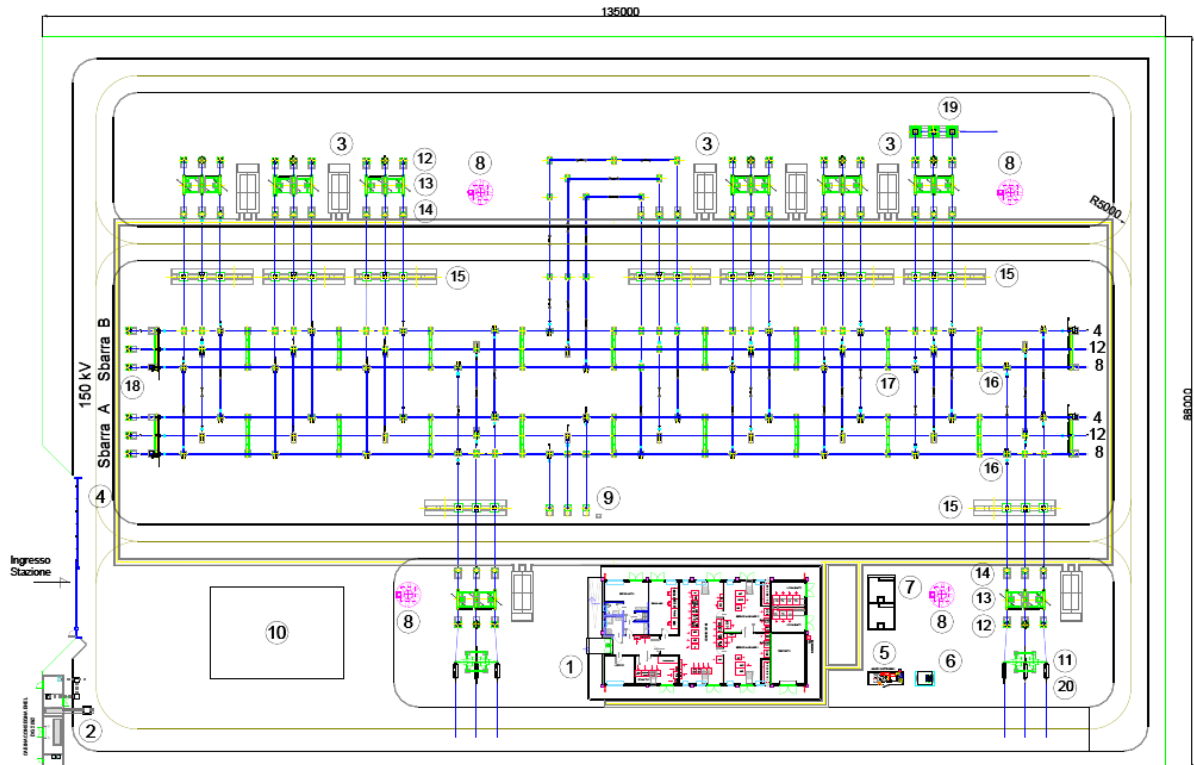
Planimetria nuova Stazione Elettrica 150 kV
